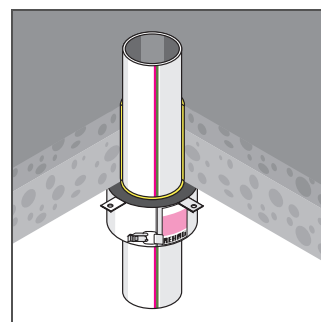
Противопожарная манжета для накладывания на перекрытие
